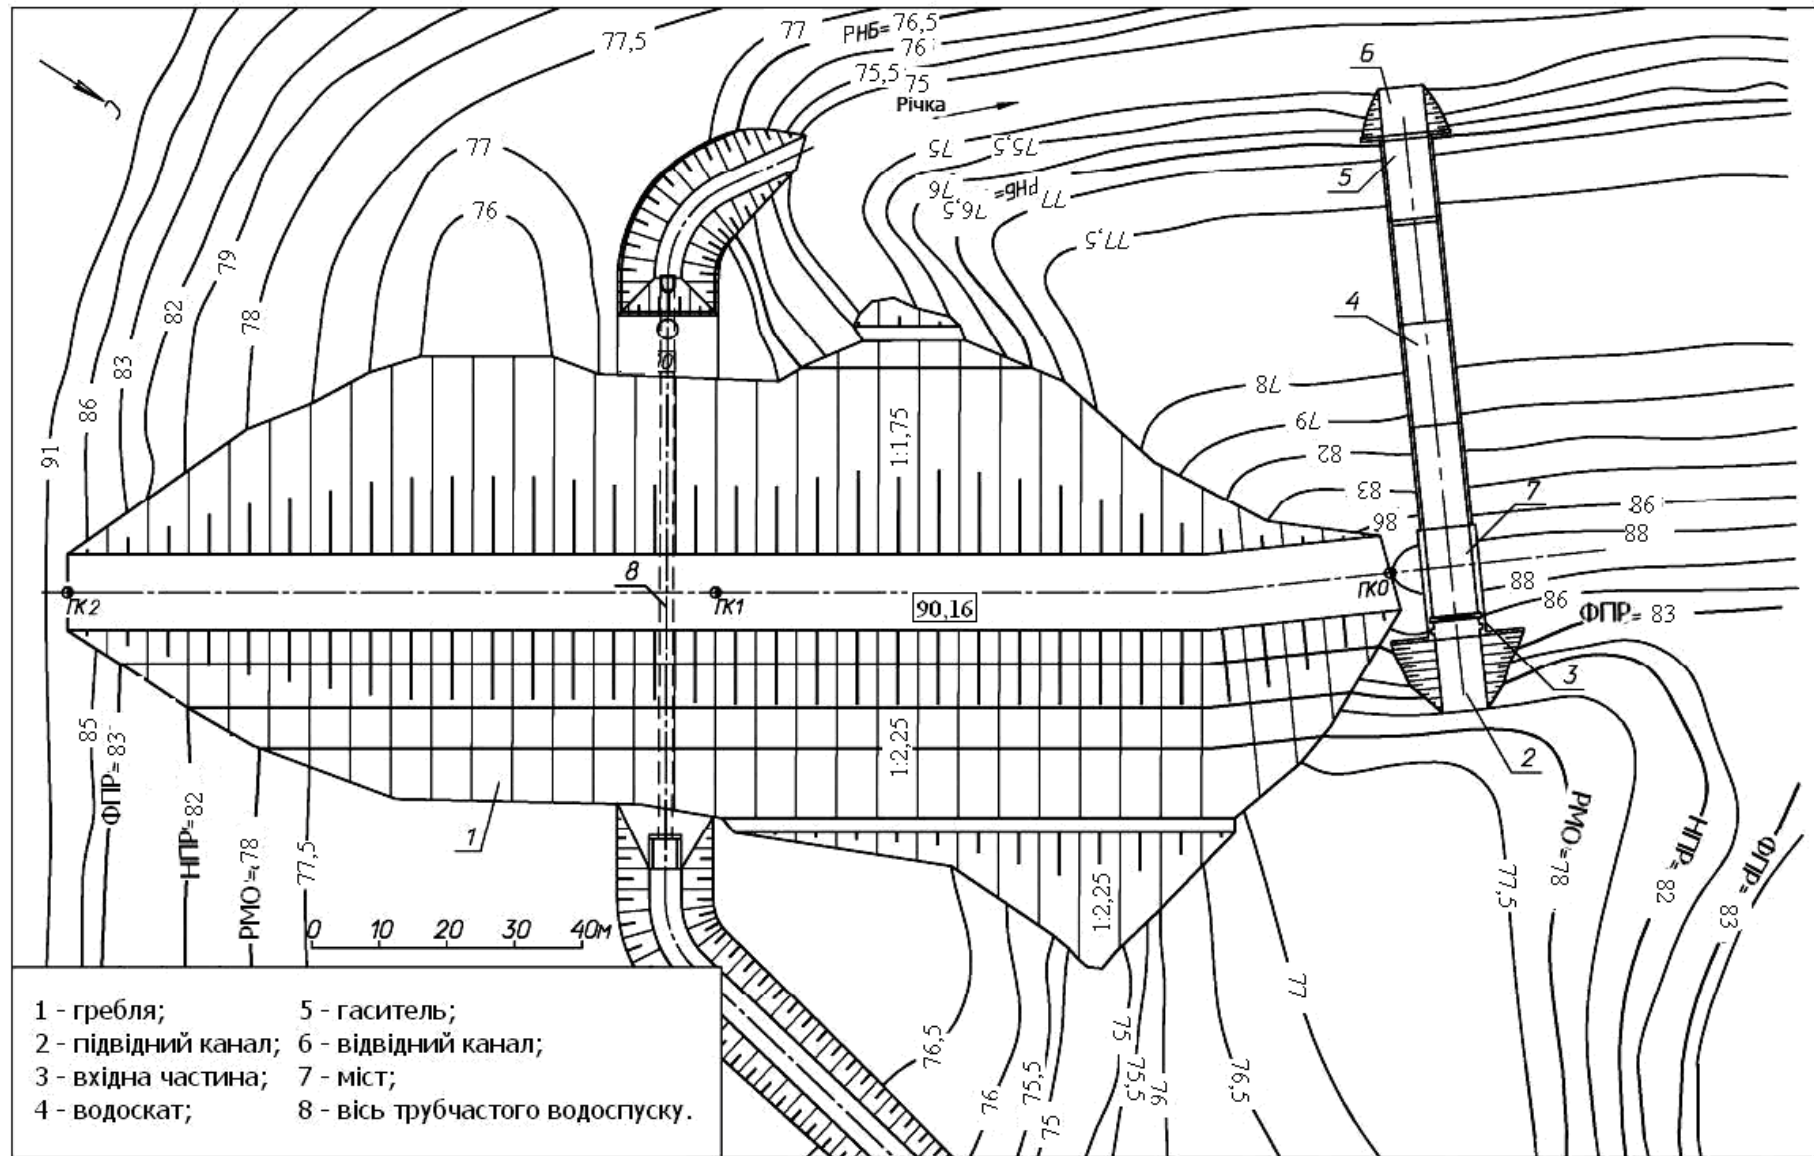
Генеральний план гідровузлу з береговим водоскидом й донним водоспуском
